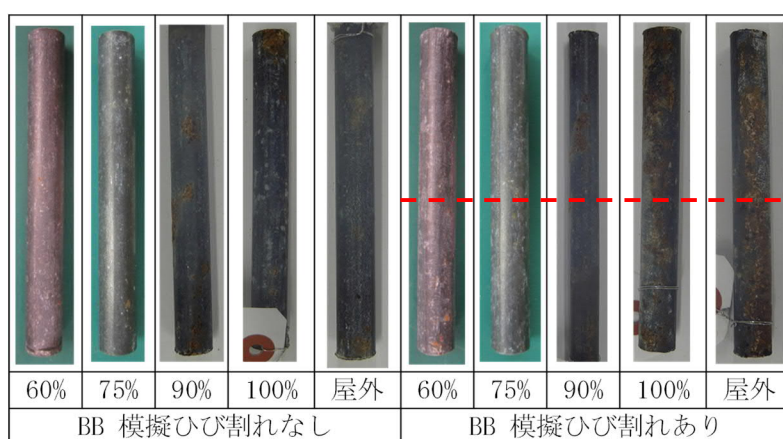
暴露試験期間終了時の鉄筋腐食状況（BB／模擬ひび割れなし，あり）
